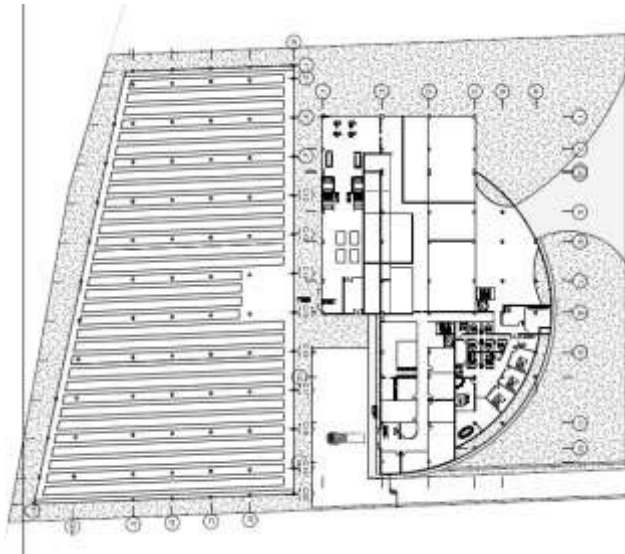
Planta Baja conjunto Procesadora de Sábila (2018)
